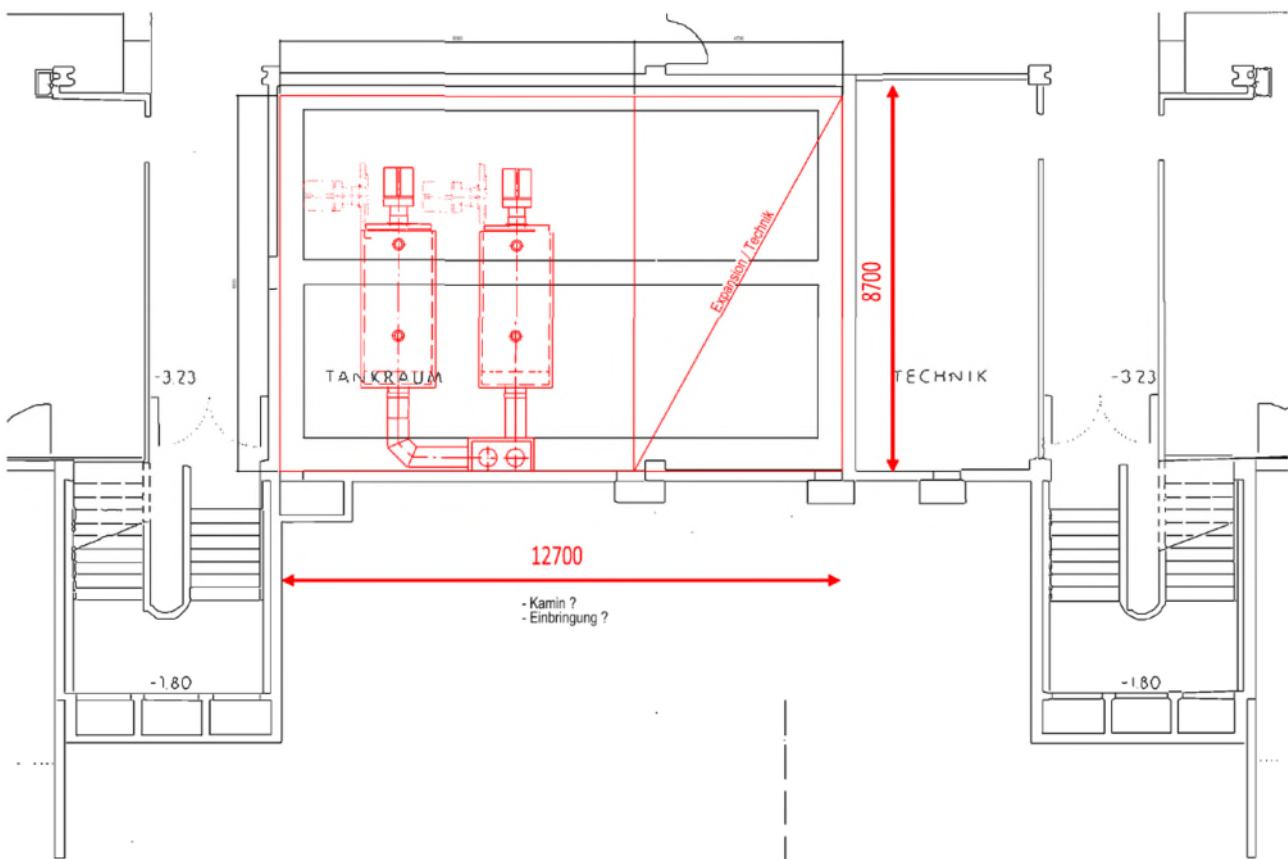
Grundriss Ölkeller Stämpflschulhaus mit Notheizung 2 x 2.6 MW
